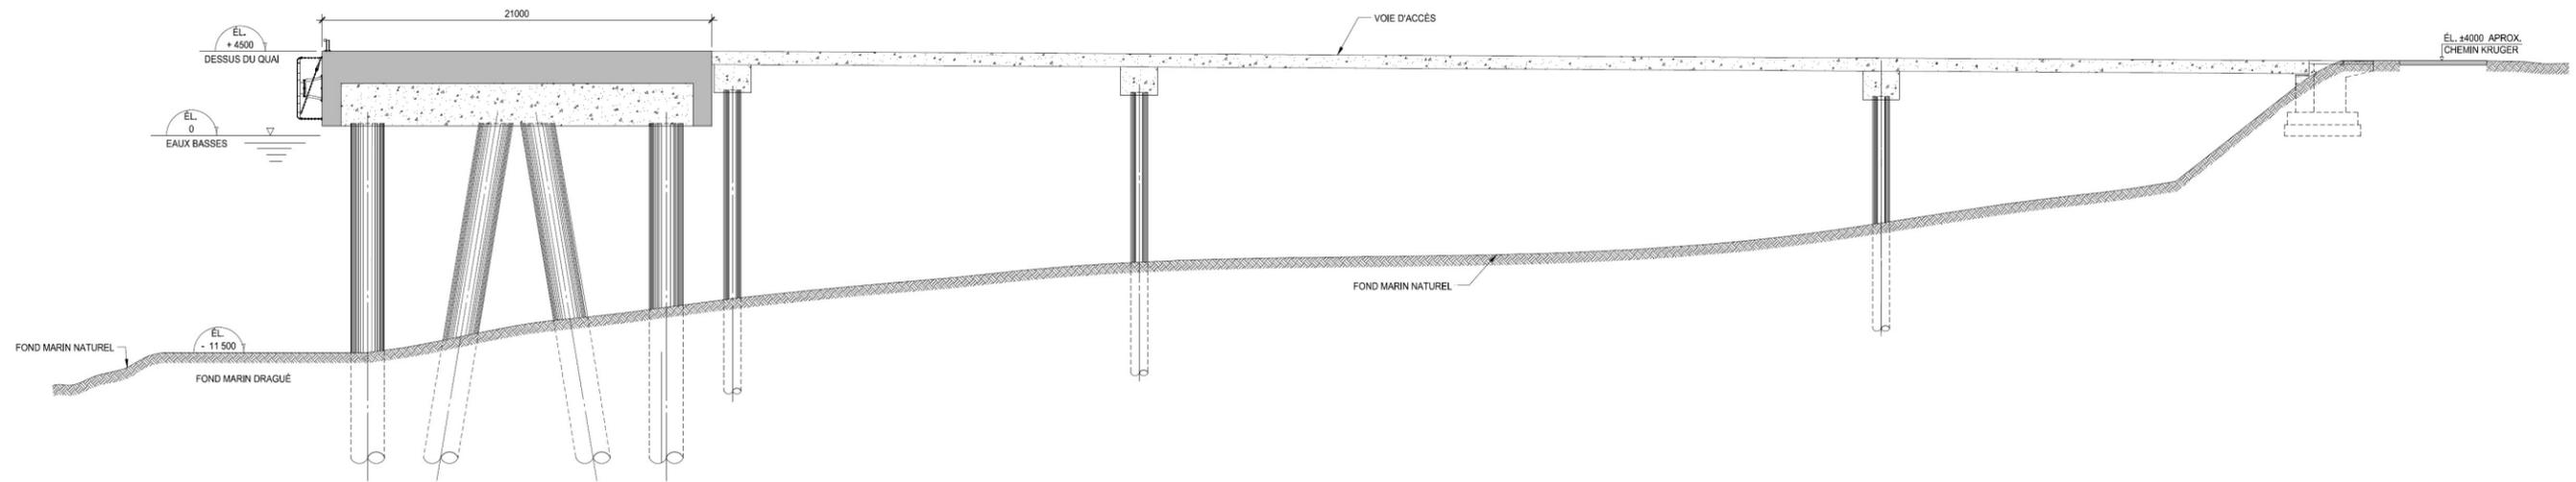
Coupe-type de la variante 3 - Dalle sur pieux avec pont sans entreposage
